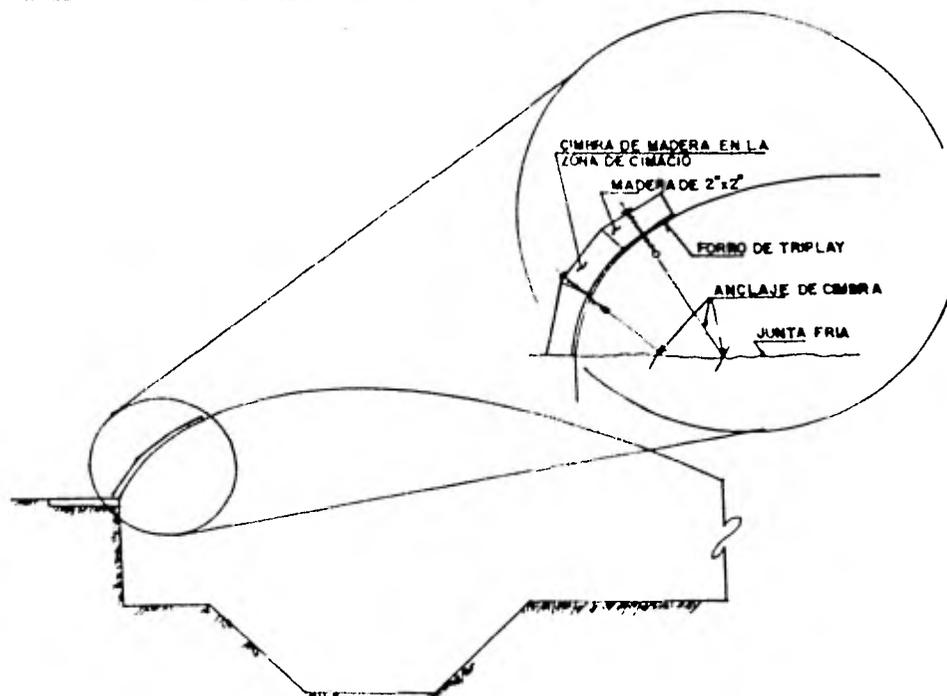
TIPO DE CIMBRA UTILIZA EN LA ZONA DE ESTRUCTURAS
